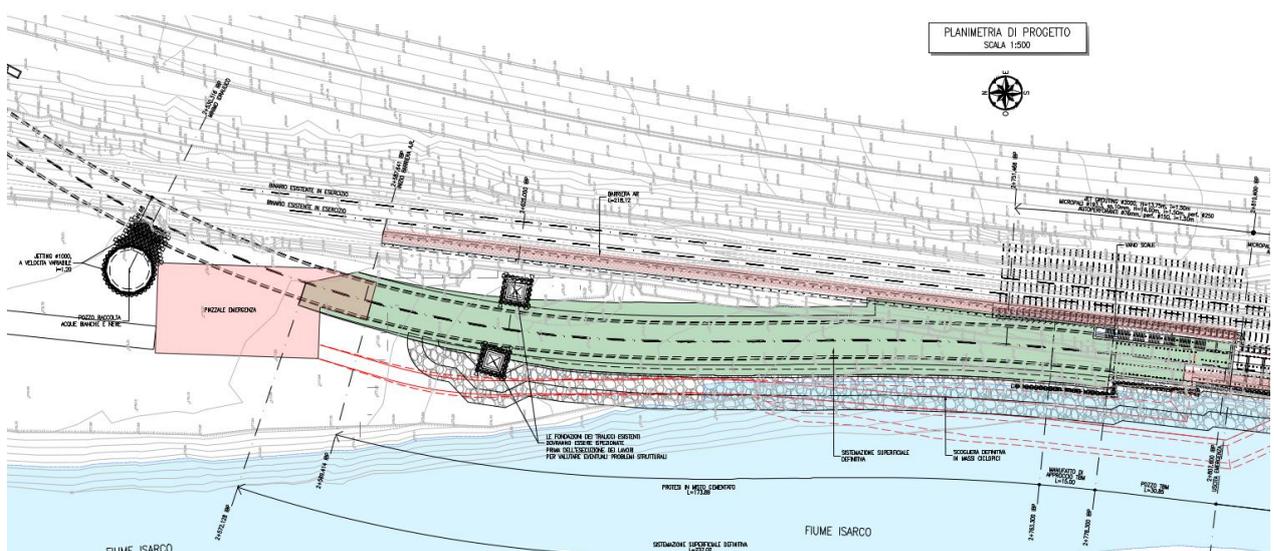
Planimetria dell'imbocco (Parte 2/2)
